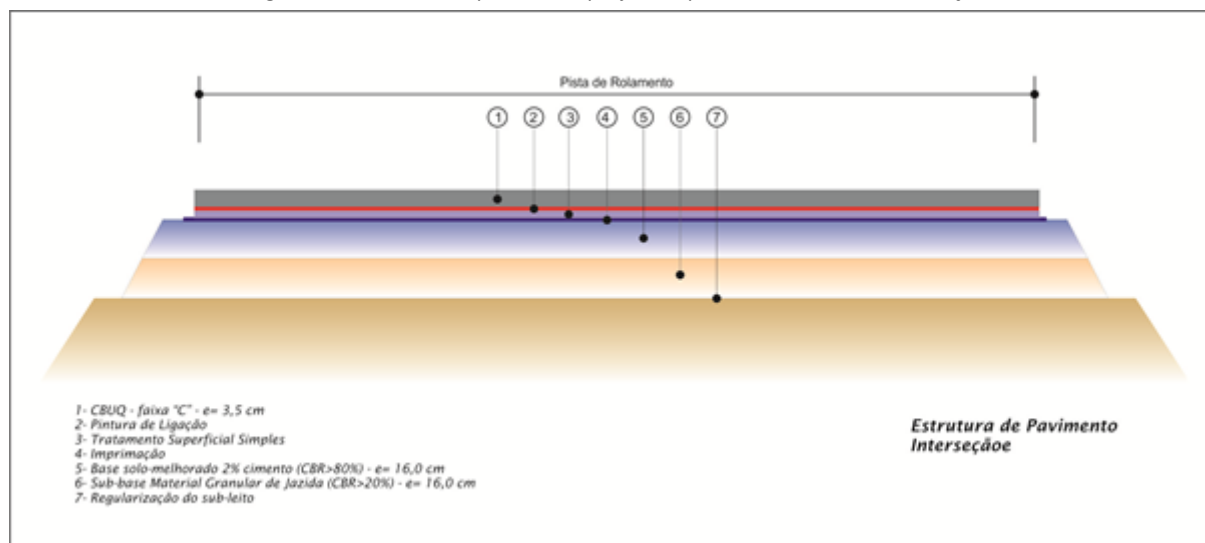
Estrutura de pavimento projetada para Interseções 01,02 e 03
